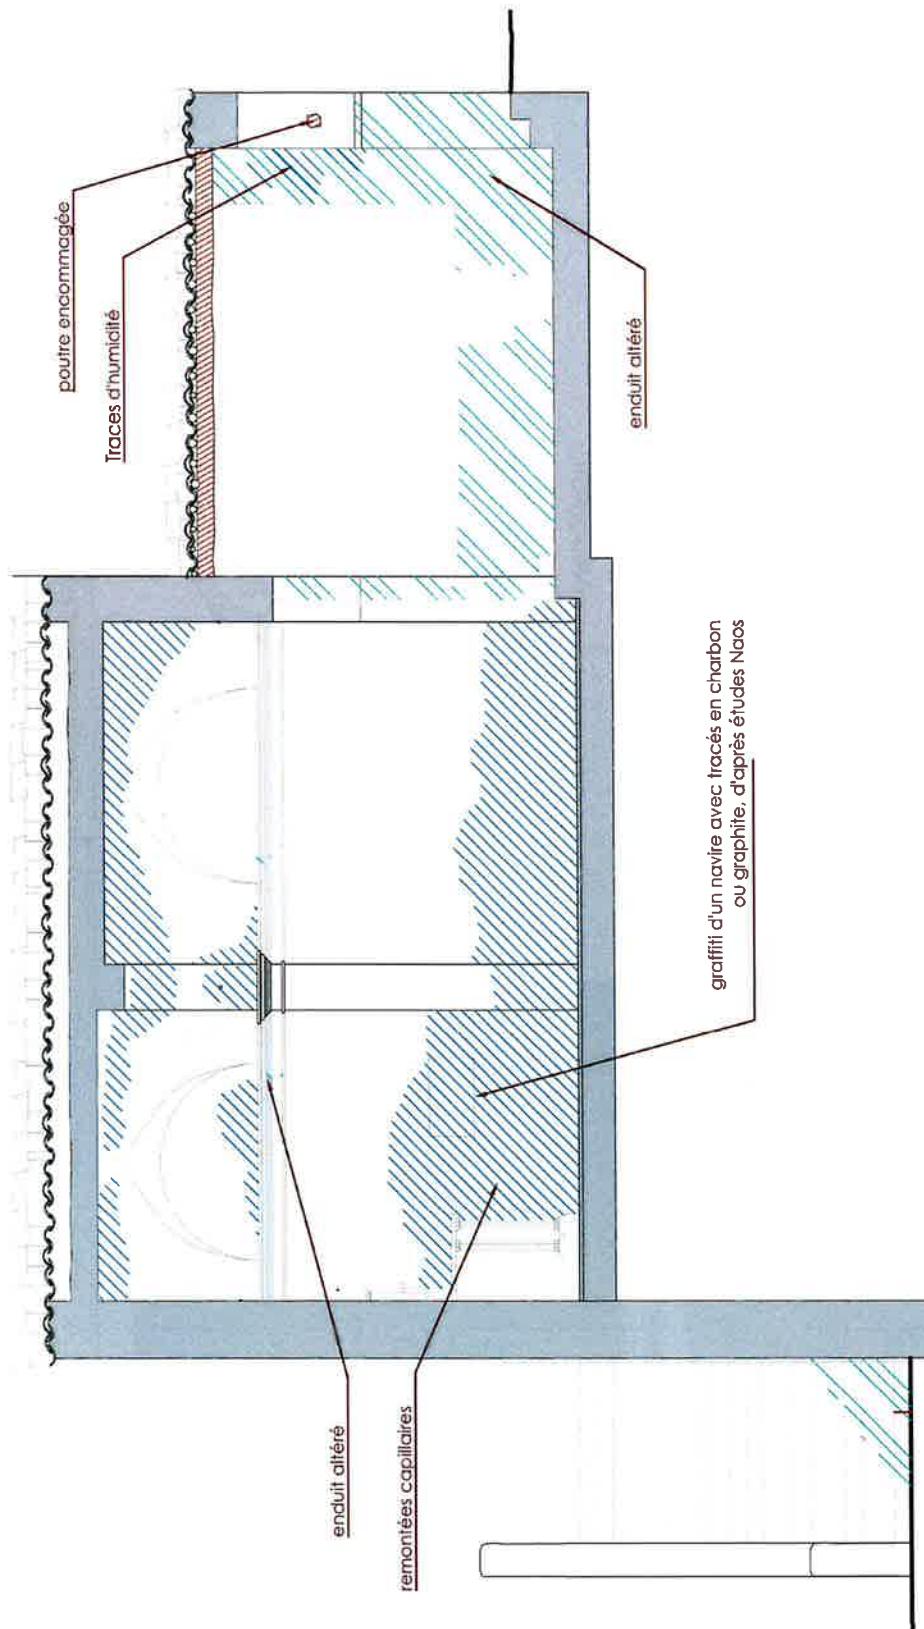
Enduit abîmé sur le mur latéral est du chœur
